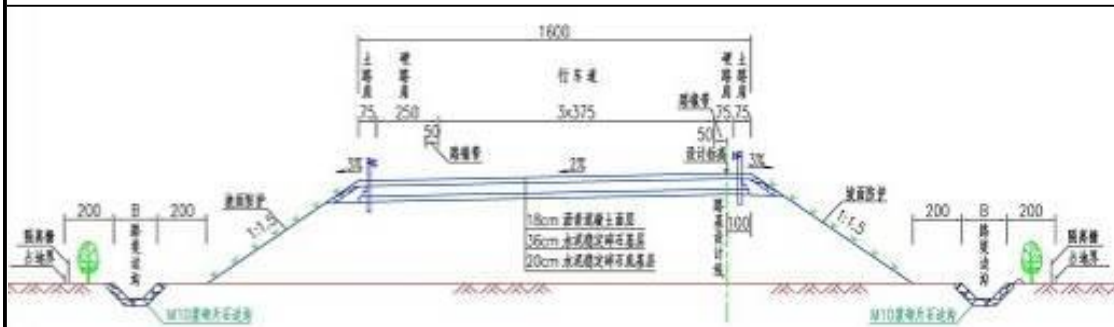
(5) 六车道路段新建段分离式路基标准横断面图 (16.0m)
